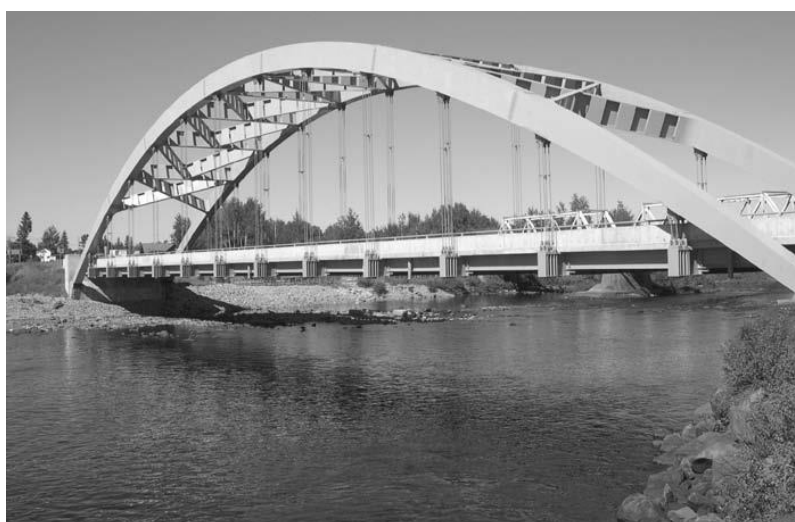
Ponte Sgt. Aubrey Cosens V.C. Memorial Bridge após a sua reconstrução. [10]
